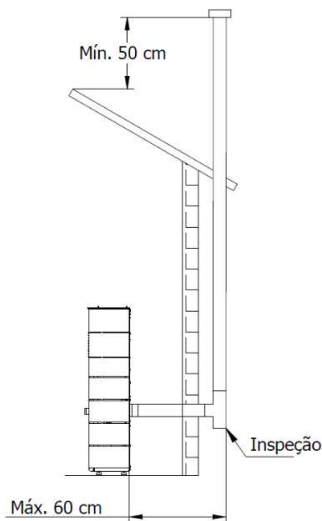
Vista lateral da instalação sem chaminé, com exemplo do ponto de inspeção
